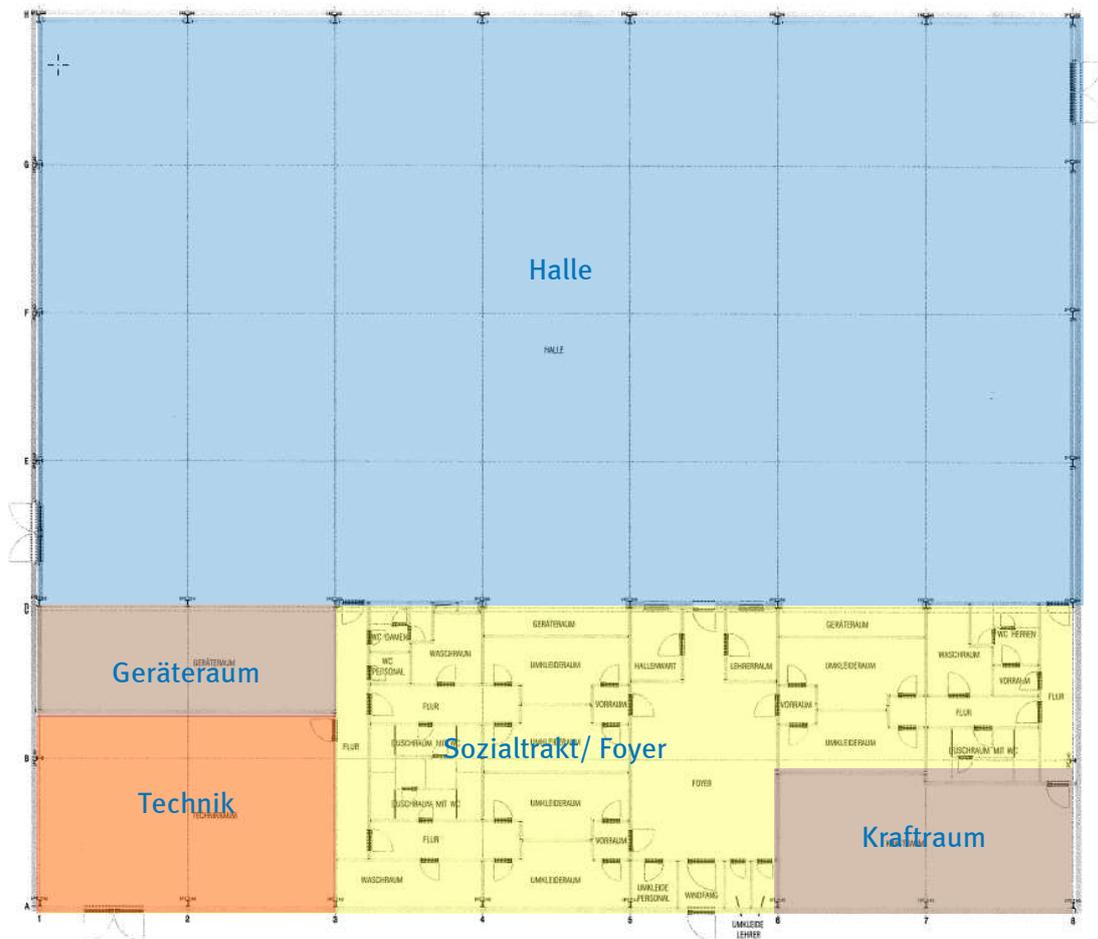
Grundriss TH 23 - Typ SH 24 x 42 (Quelle: ZGM)
